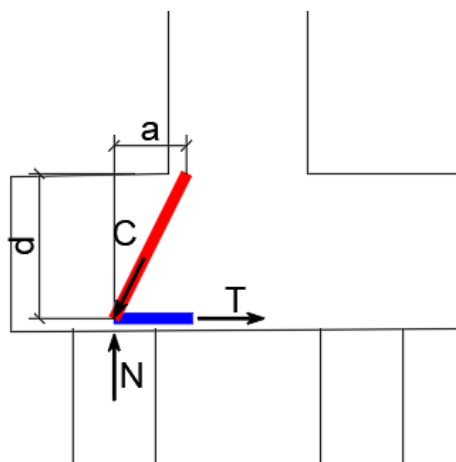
Schema tirante-puntone sulla piastra di fondazione
